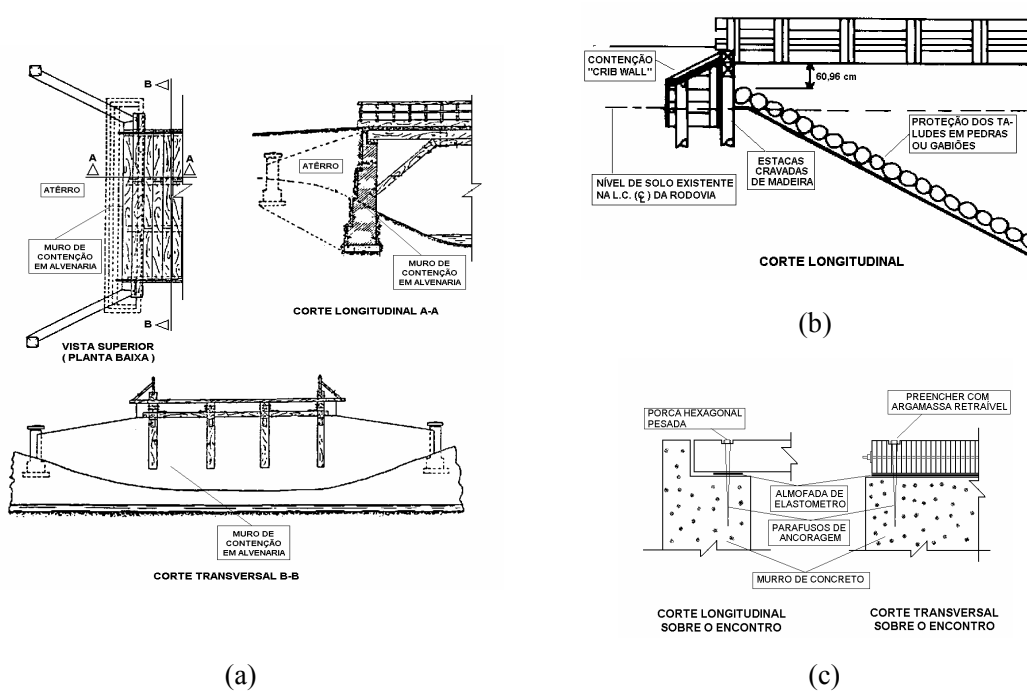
(a) Fundação em muro de alvenaria; (b) Fundação em estaca de contenção “crib wall”; (c) Fundação sobre muro de concreto
